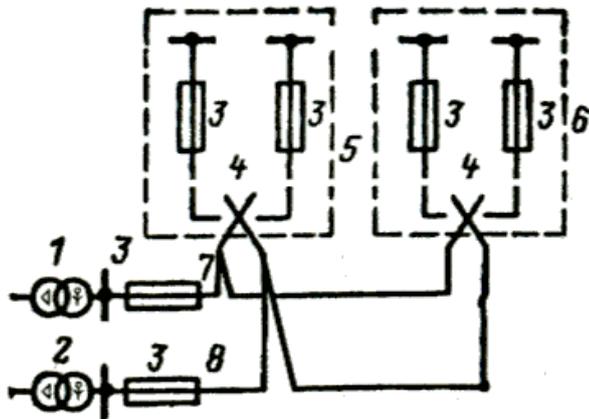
Принципиальная схема электроснабжения жилых домов высотой 9-16 этажей с двумя переключателями на вводах:
